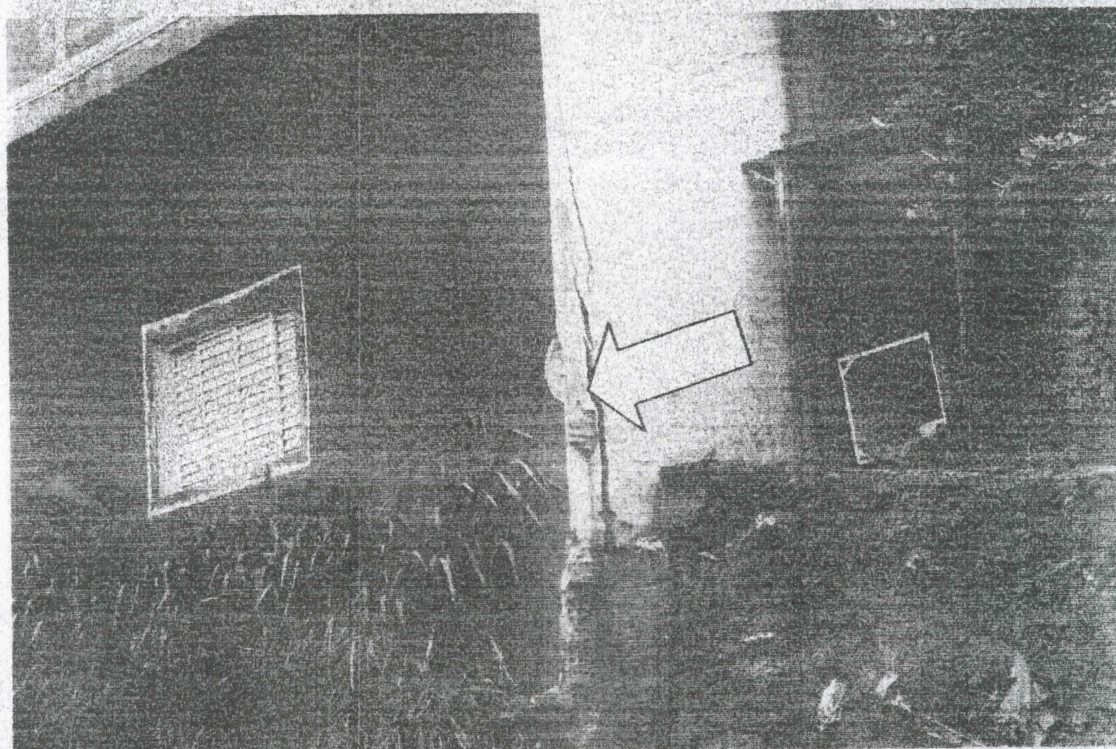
Edificação N°20 com fissuras e deslocamento estrutural.
